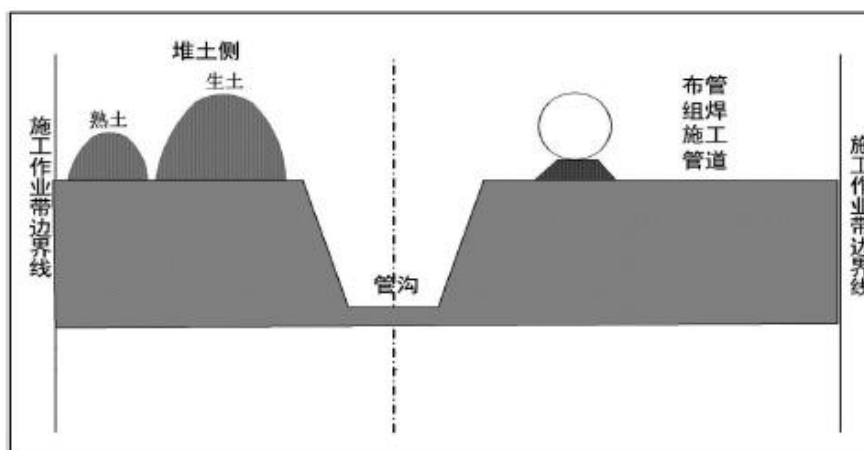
一般地段管线施工方式断面示意图（大开挖）
